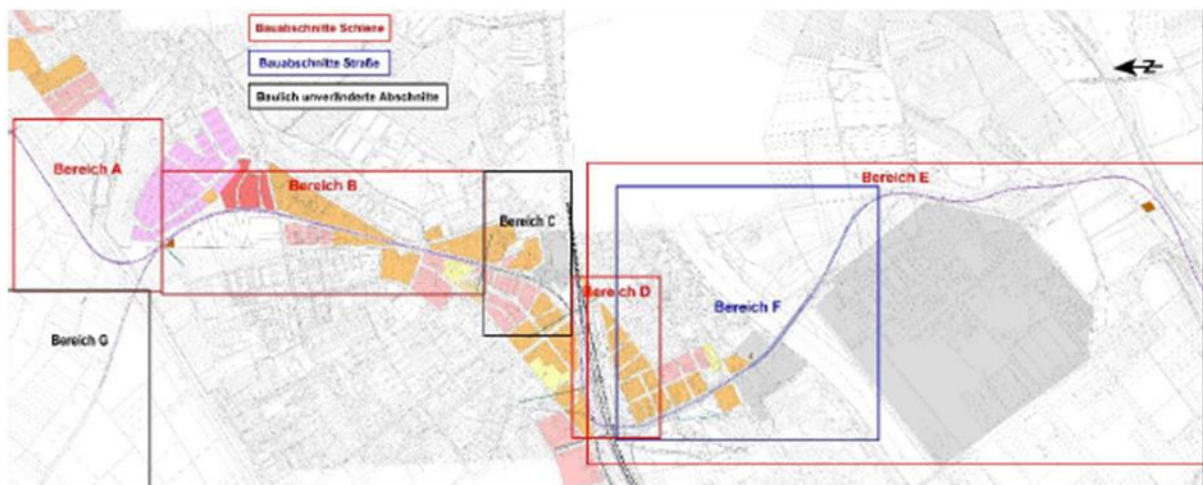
Bereiche unterschiedlicher immissionsschutzrechtlicher Einstufung, Quelle: RTW, Planfeststellungsunterlage, Anlage 20.1b, 2023
